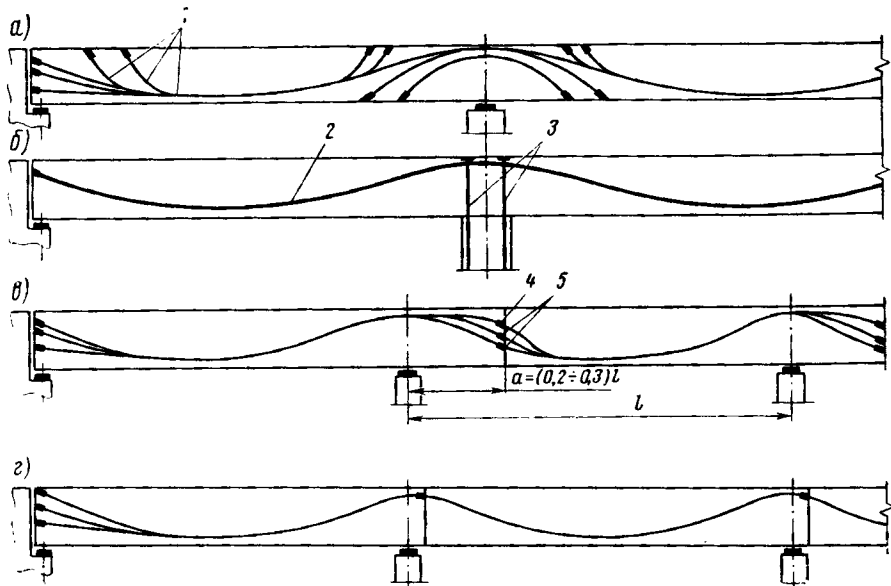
Схема армирования продольной напрягаемой арматурой ребристых монолитных пролетных строений:
